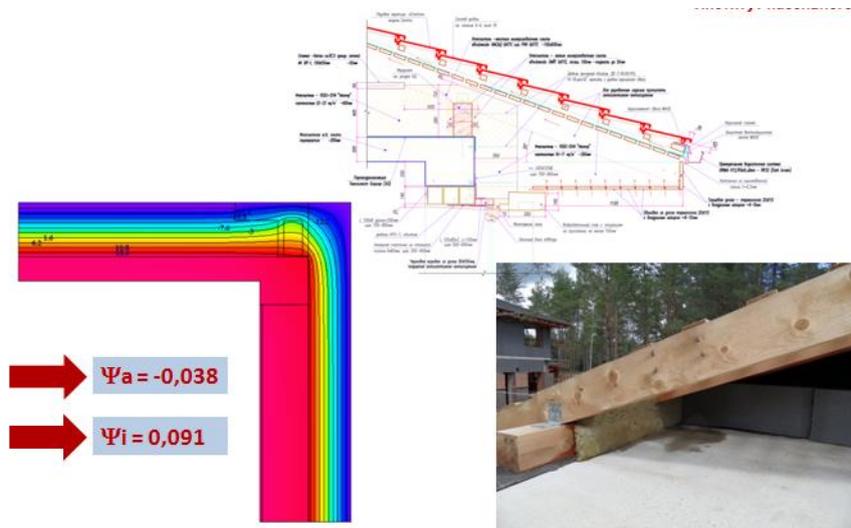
Примыкание чердачного перекрытия и наружной стены.
